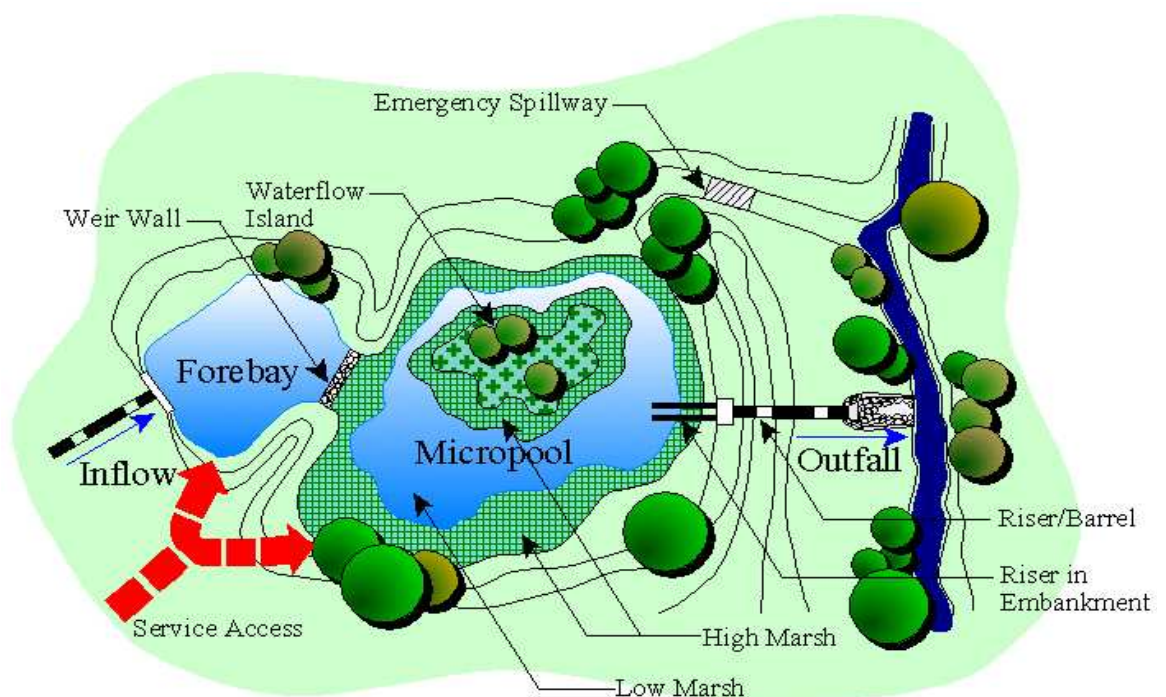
Banhados construídos (Constructed Wetlands) Planta.
